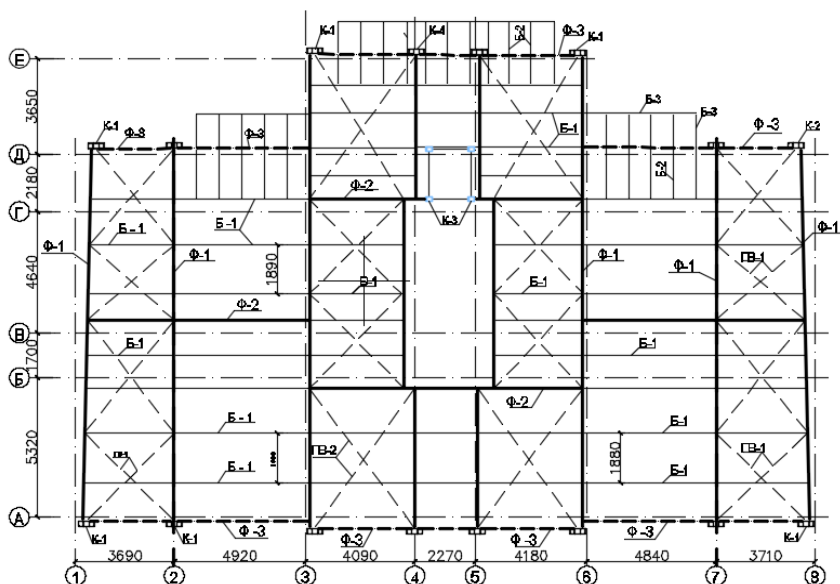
План розташування металевих ферм та балок над горіщним перекриттям.
